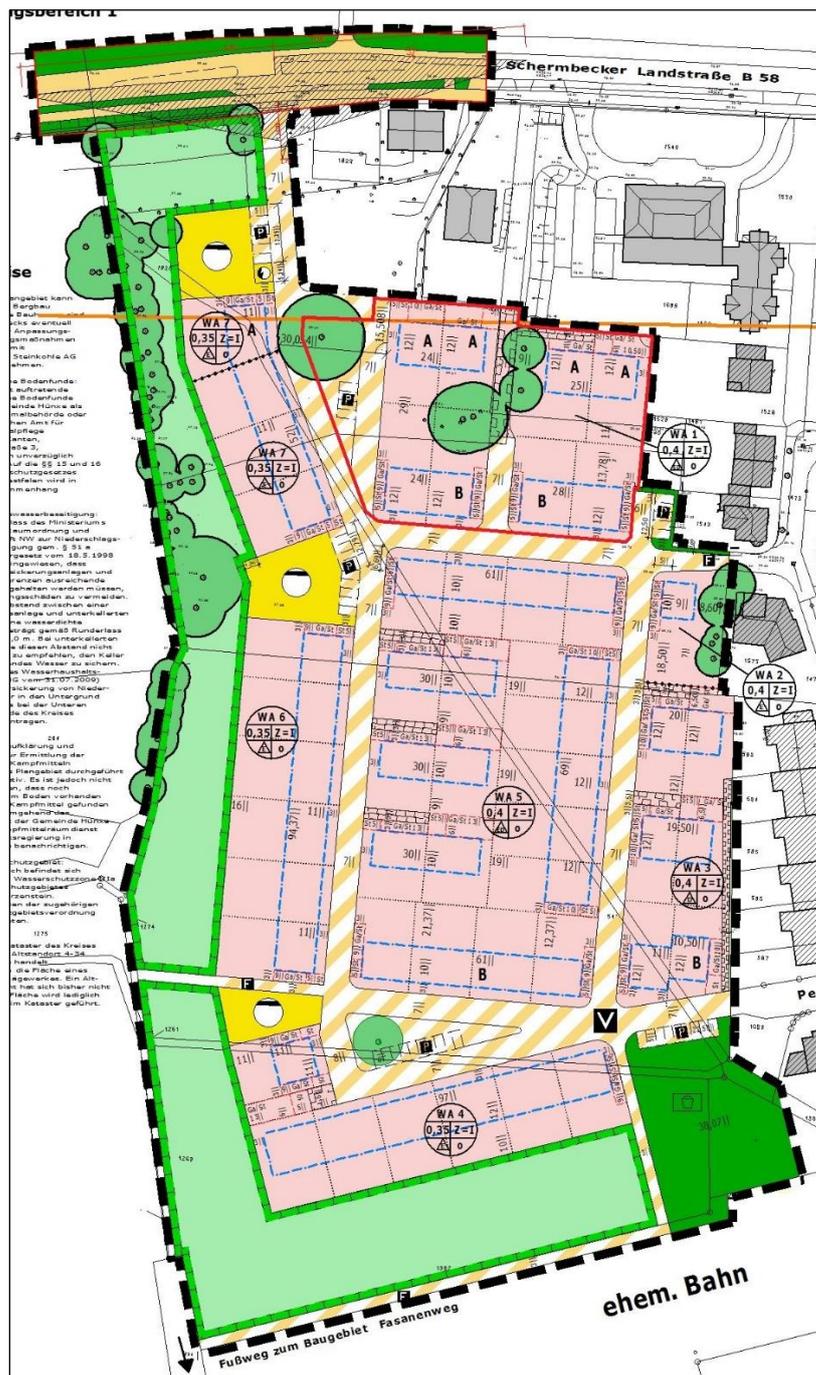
Planzeichnung des Bebauungsplanes Nr. 45 (Ausschnitt) /14/ mit Darstellung des Änderungsbereiches (rot umrandet)
